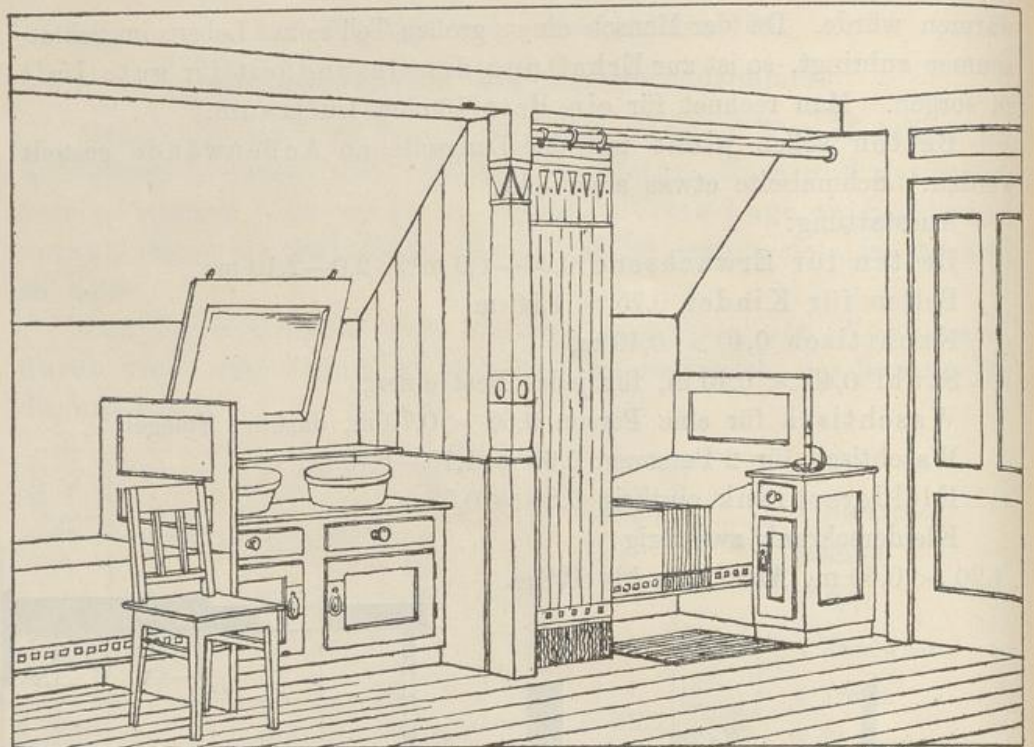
Kinderschlafzimmer im Dachgeschoß. Stuhlsäule zwischen Bett und Waschtisch.
